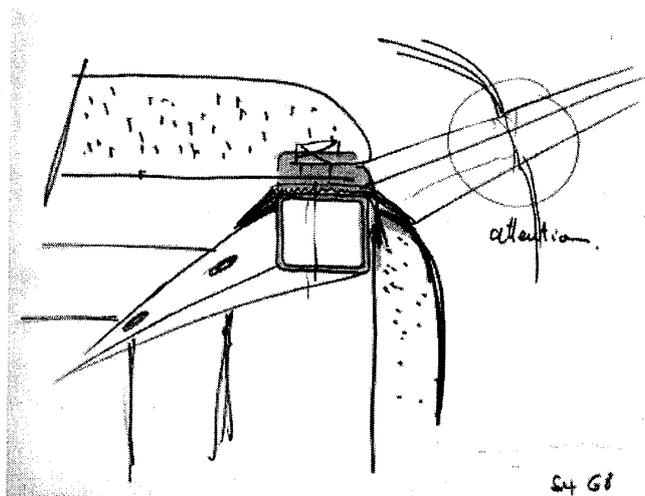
矩形状建物の断面詳細図 (スケッチ) 208 × 268
